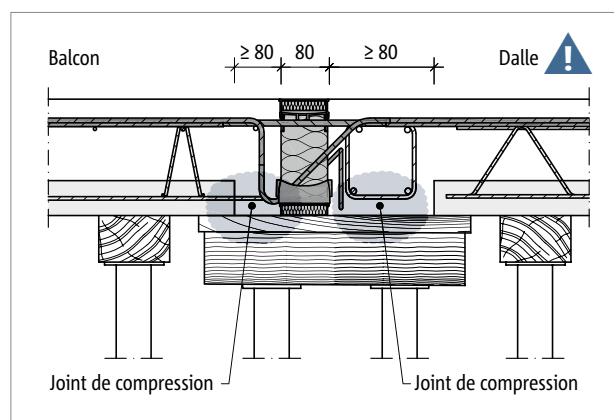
Schöck Isokorb® T types K-E, K-T : montage dans plancher en prédalles avec poutres de rive
